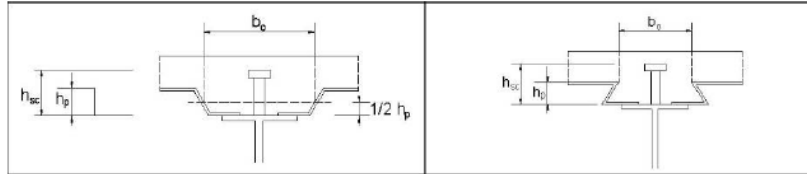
(a) - Disposizione della lamiera grecata rispetto al profilo in acciaio
